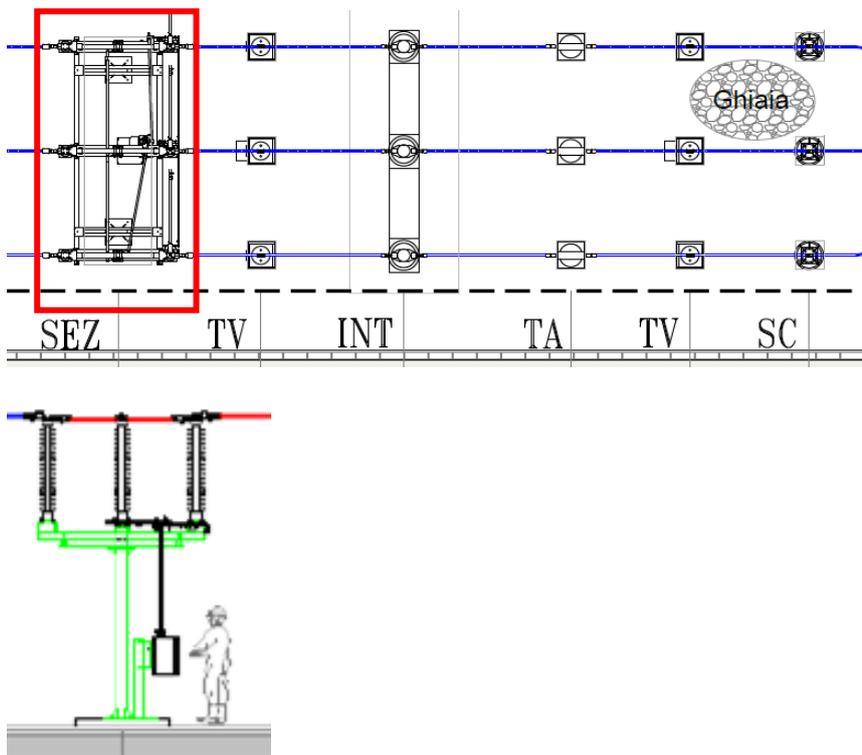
\_vista sezione elettromeccanica Apparecchiature AT
